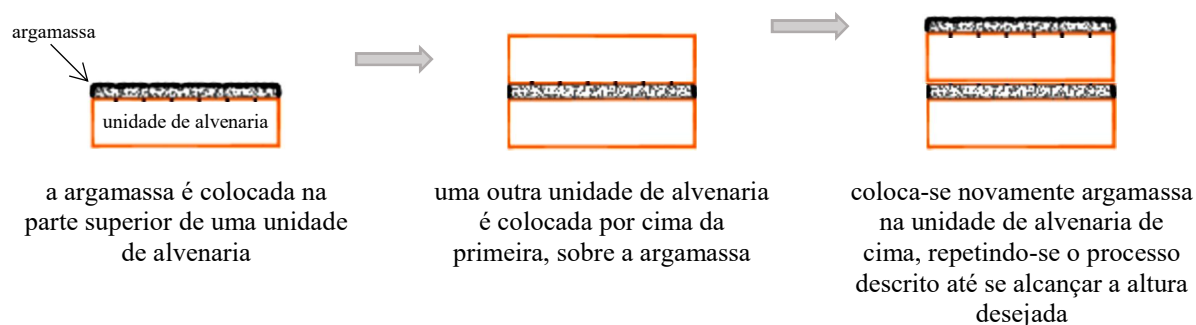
Aplicação da argamassa de assentamento (adaptado de [75])
